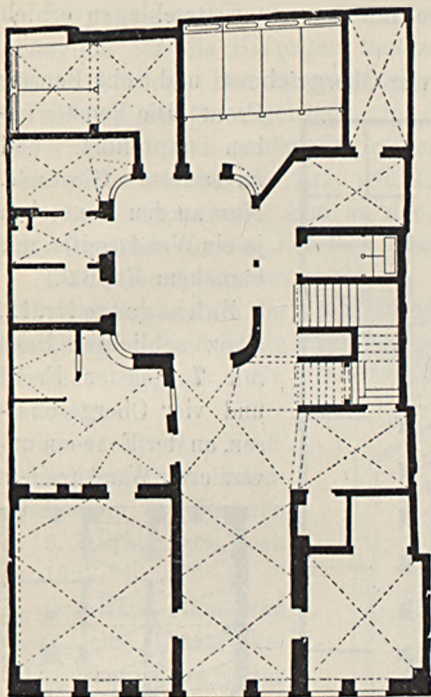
Kleine Brüdergasse Nr. 19. Erdgeschoss.
